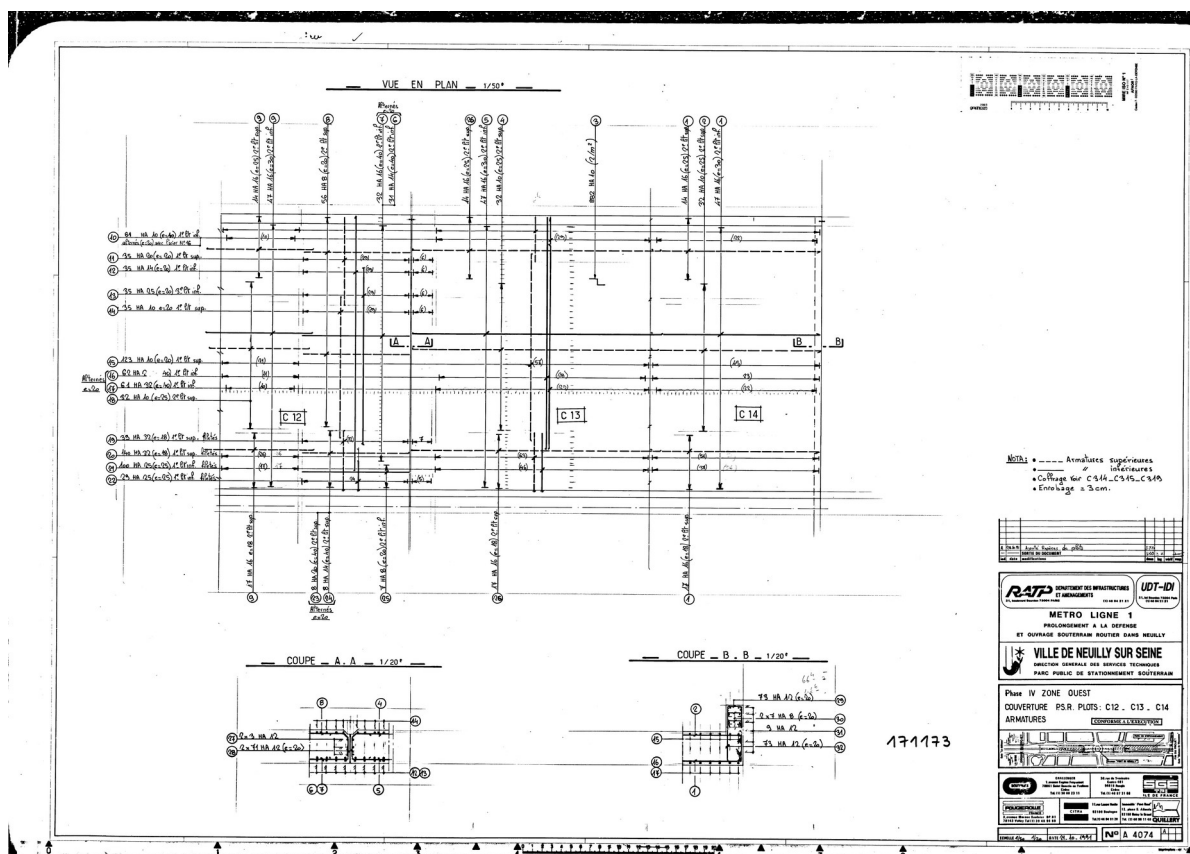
Ferrailage traverse C14 et C13_plan 171173
